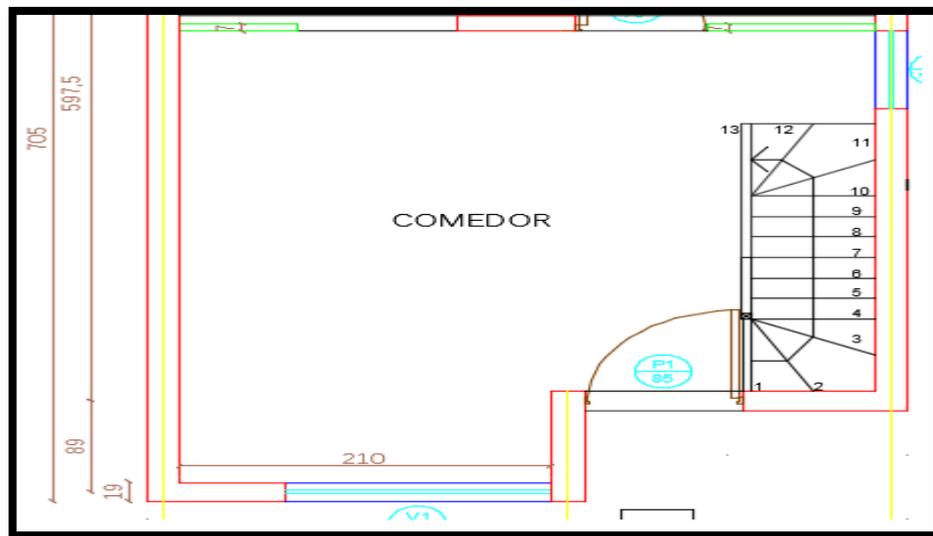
Planta del Living comedor (Dimensiones en cm)
